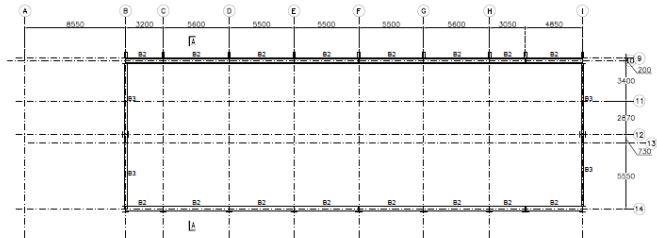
Denah atap elv. +14.75 sampai +16.35
